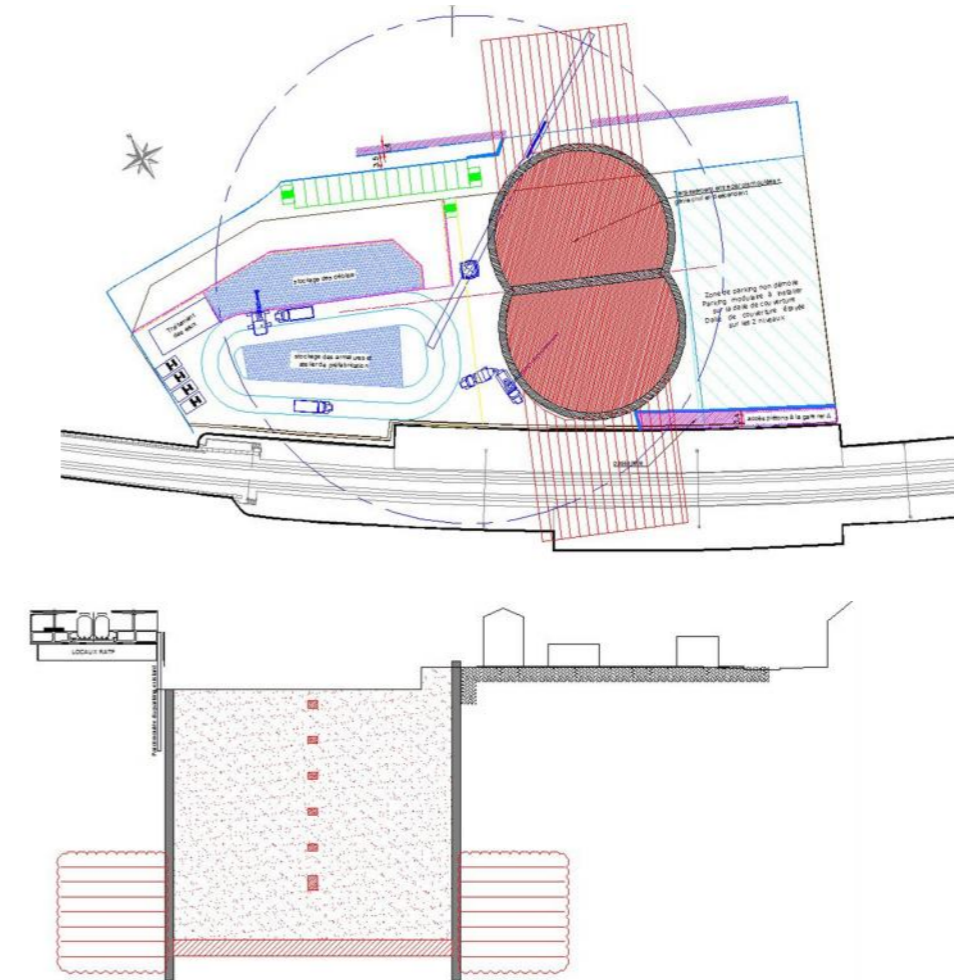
Etape 3 – Emprise de chantier et travaux entre parois moulées
